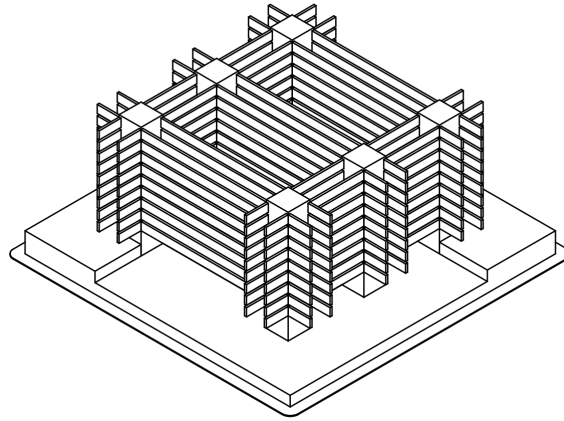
Unidad 5. Axonometría del planteamiento estructural (núcleos estructurales y vigas) [Figura] Elaborado por los autores en 2017.
